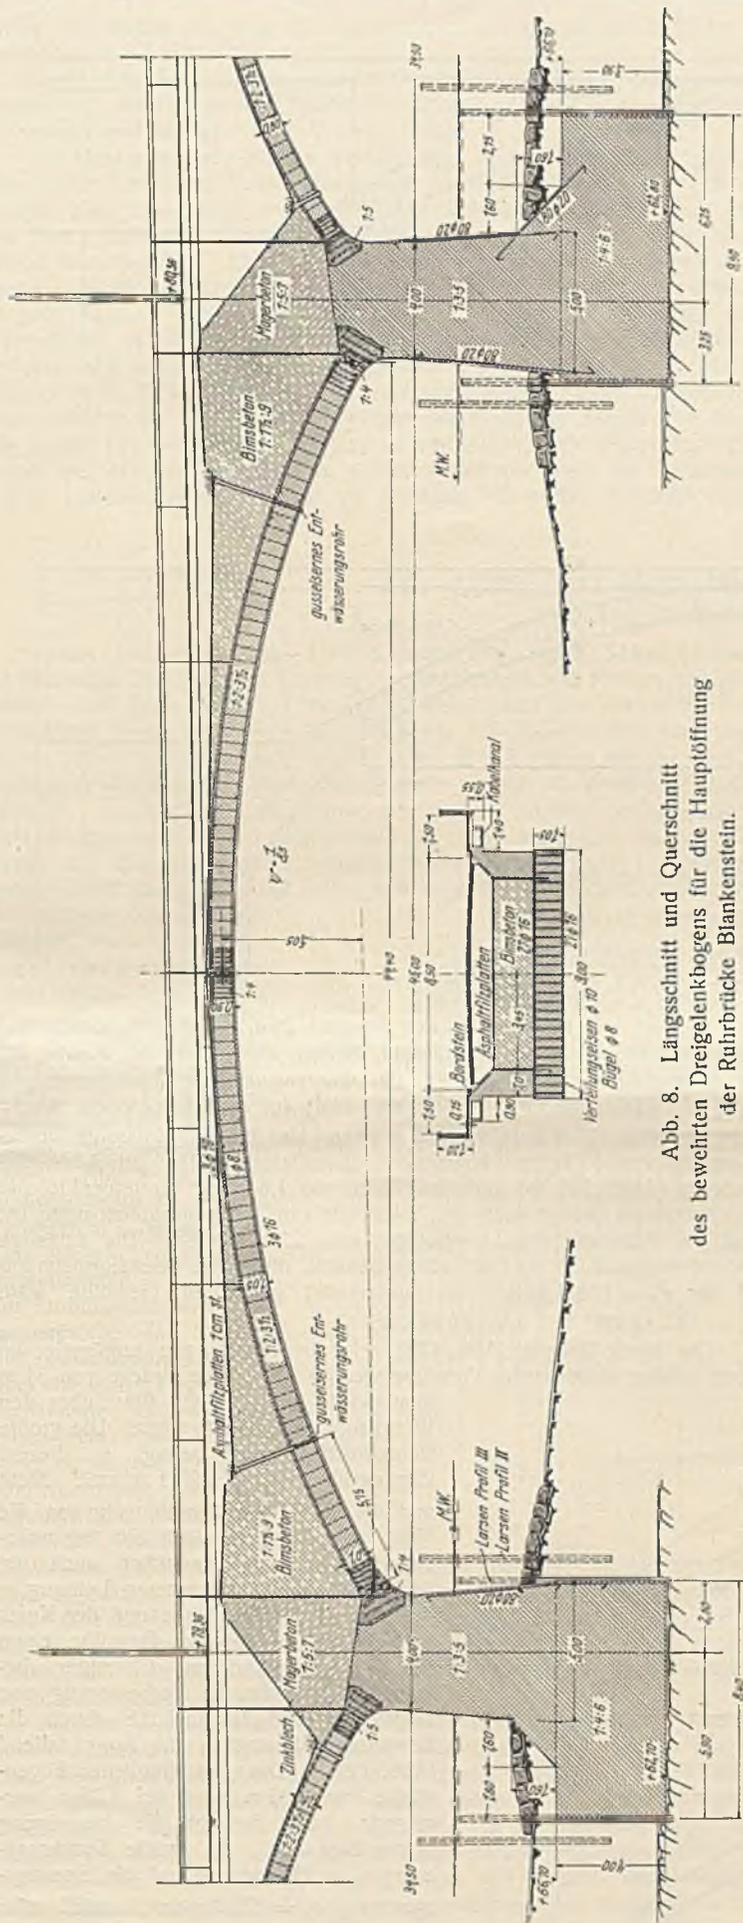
Längsschnitt und Querschnitt des bewehrten Dreiecksbogens für die Hauptöffnung der Ruhrbrücke Blankenstein.
